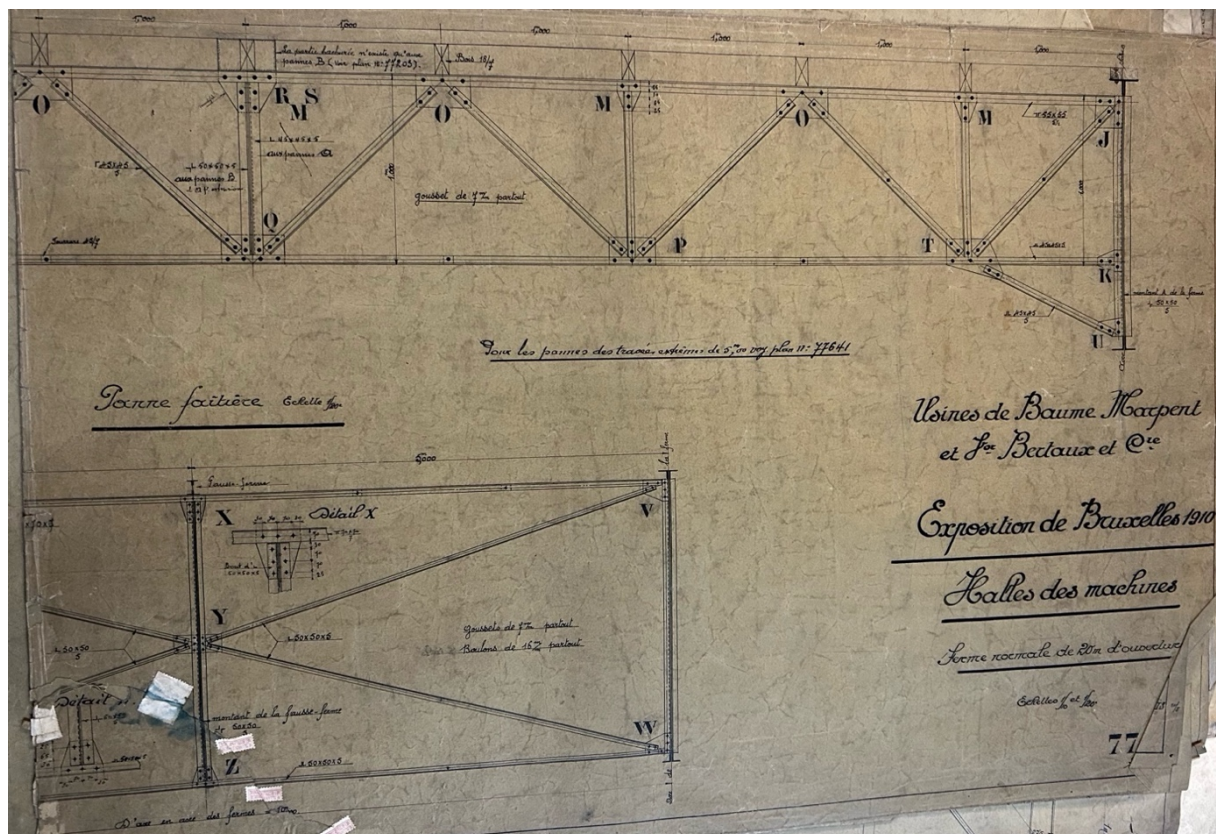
Plan en élévation des pannes, Exposition de Bruxelles 1910
